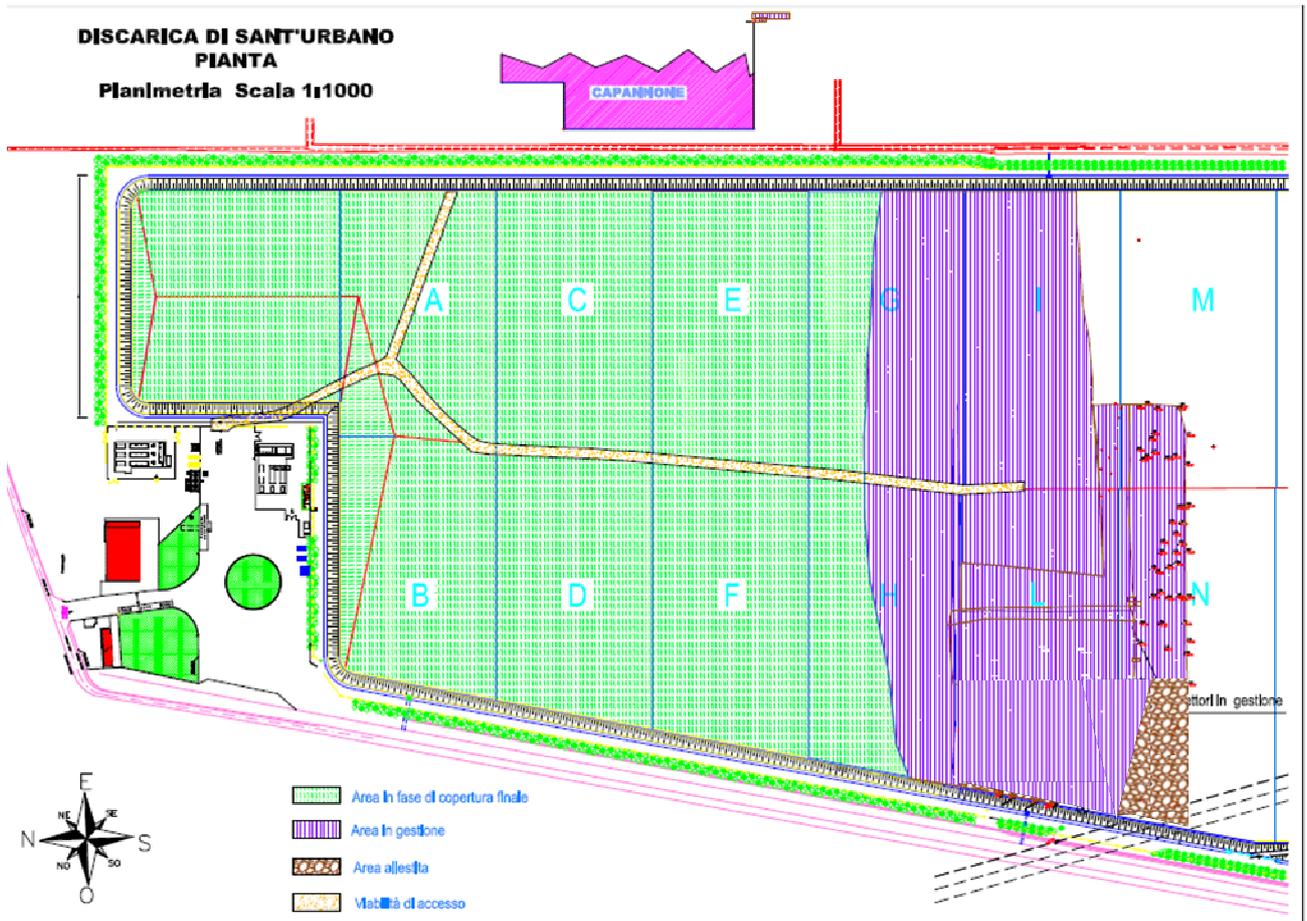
Planimetria dello stato di avanzamento lavori con evidenziate l'area in gestione e in allestimento (al 19/06/2014)
